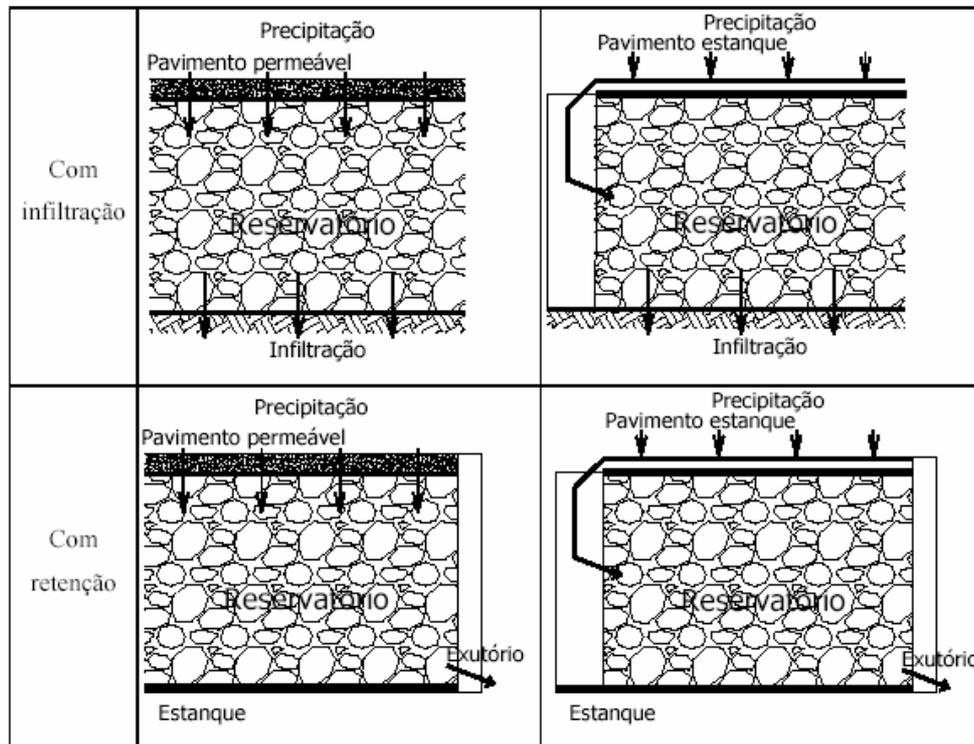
Arranjos de pavimentos com estrutura de reservação (Azzout *et al.* 1994)
